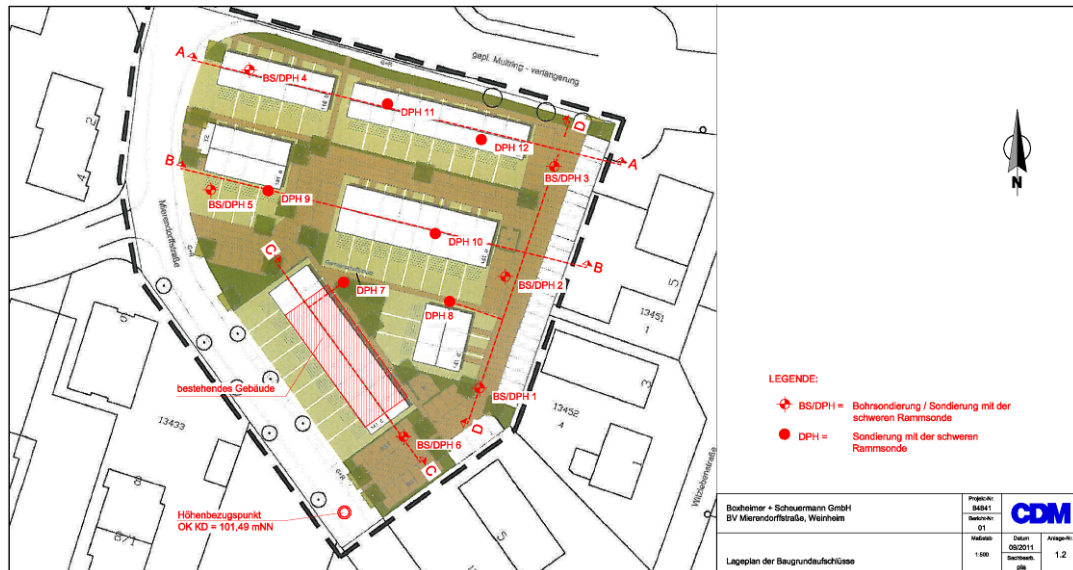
Lageplan der Baugrundaufschlüsse
